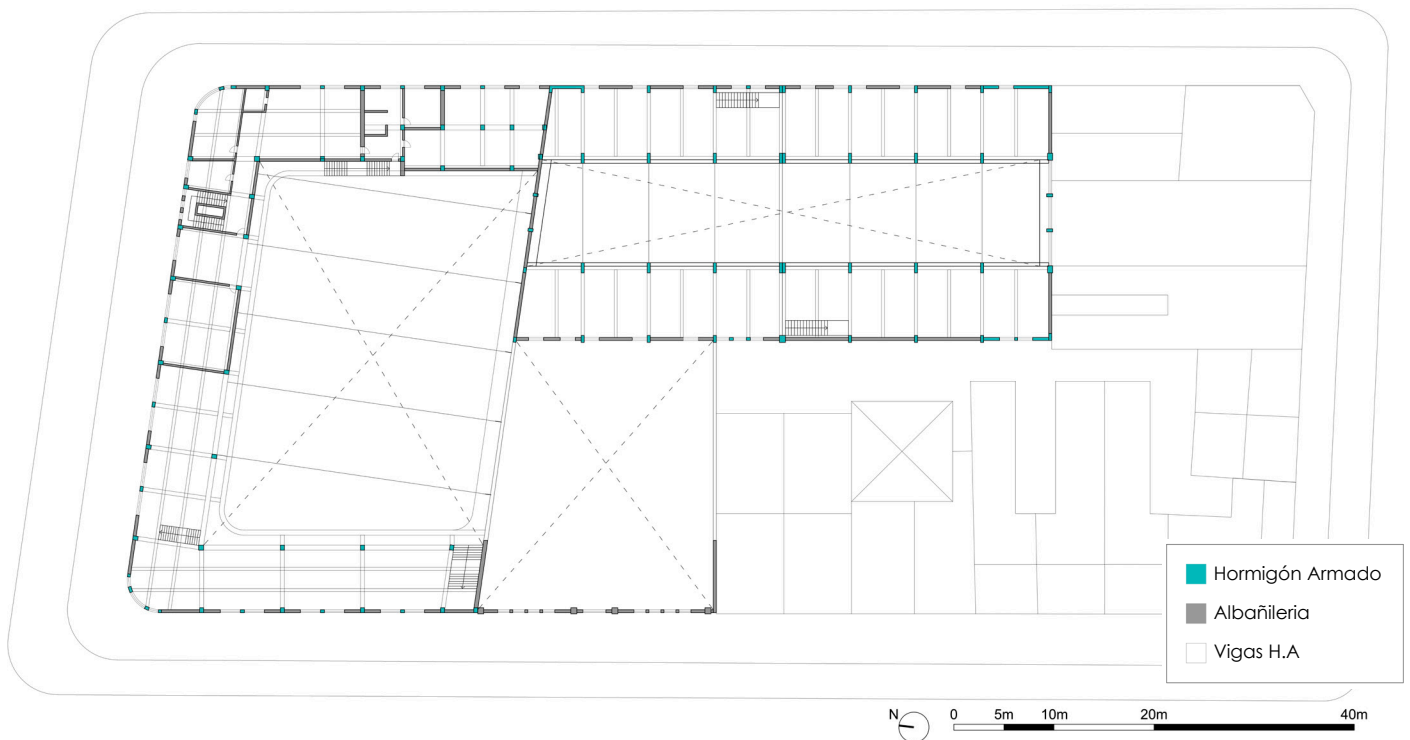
Planta Nivel 2 Ex Fundición Metalco. Fuente: elaboración propia.
